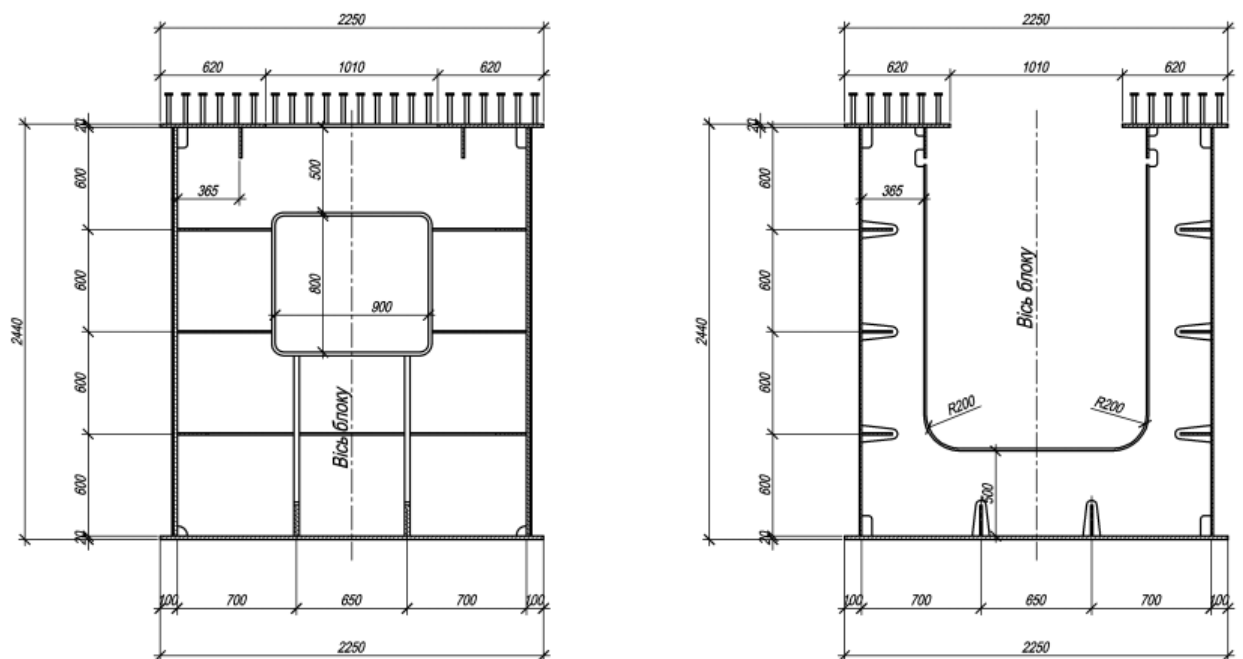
Блоки коробчастих балок. Споруда №13.
